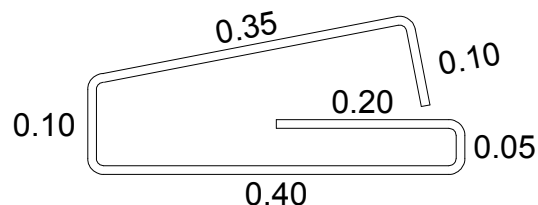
Detalle del Fleje de Placa Superior del Pozo de Inspección
